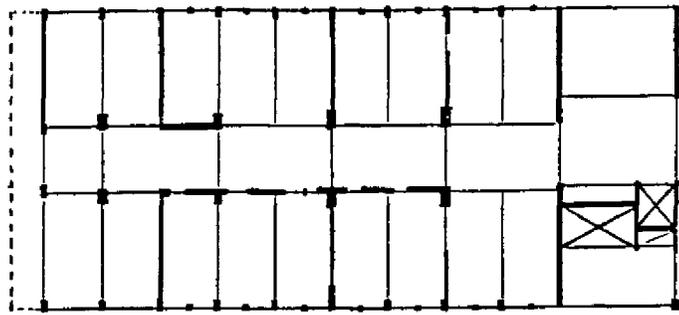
Plantas Estructurales típicas del Cuerpo B.
